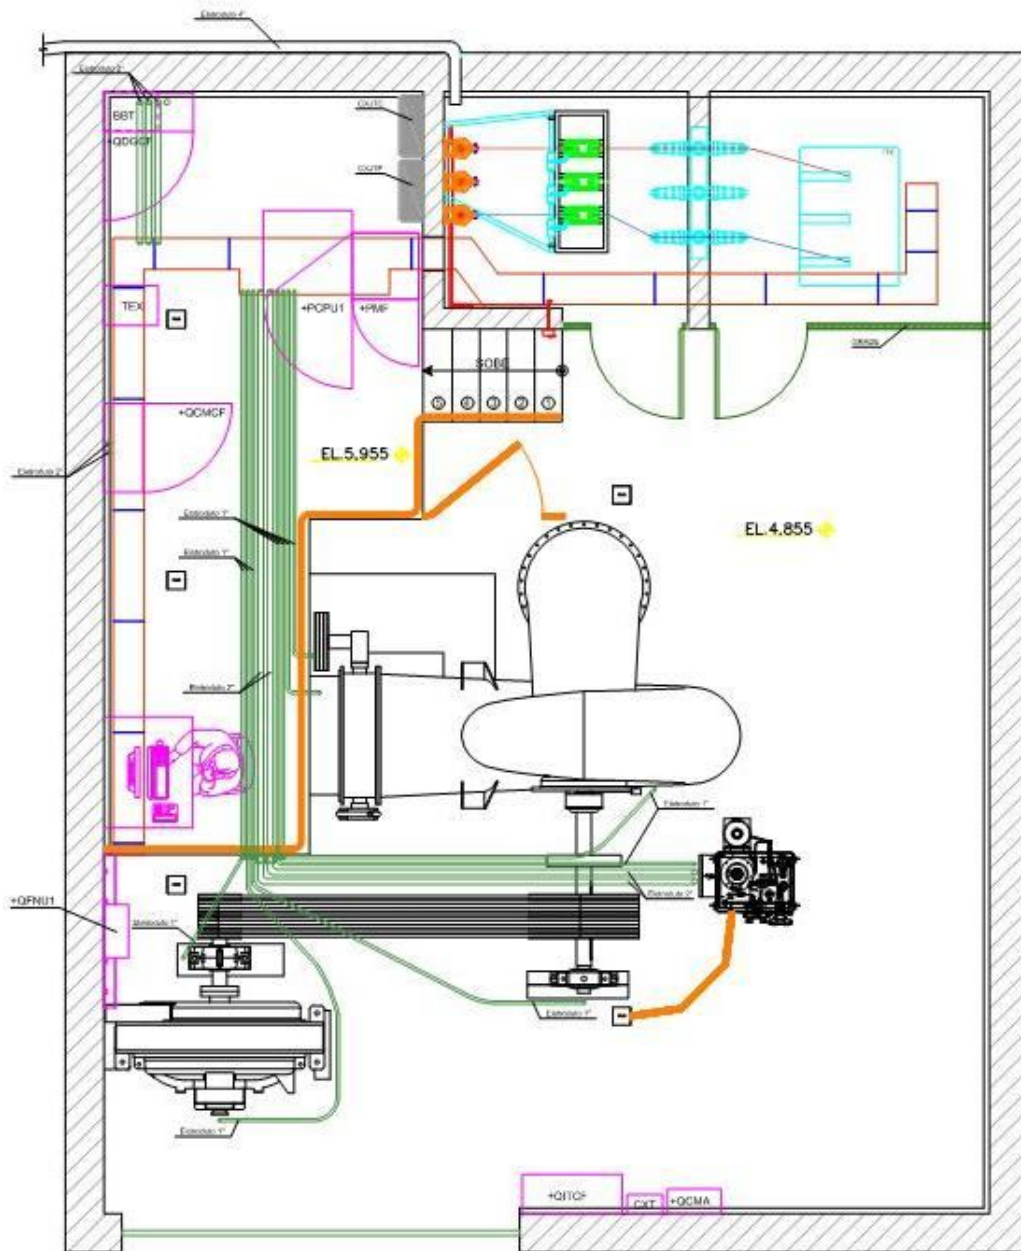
Layout da Casa de Força e Subestação Abrigada.
